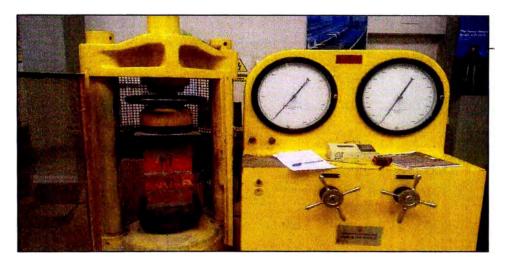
Aplicación de carga axial en pila de albañilería.
